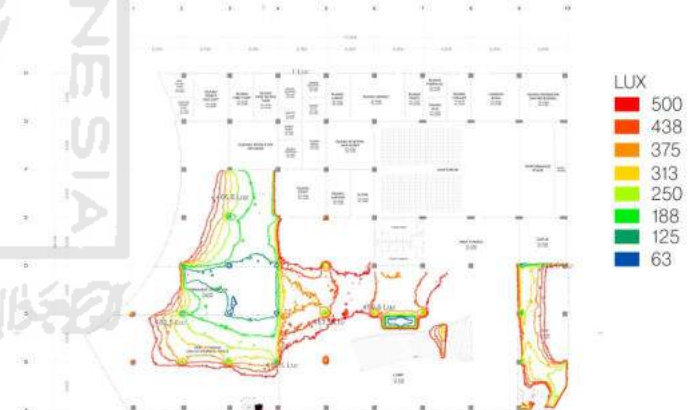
Denah (Sumber: Penulis, 2021)
